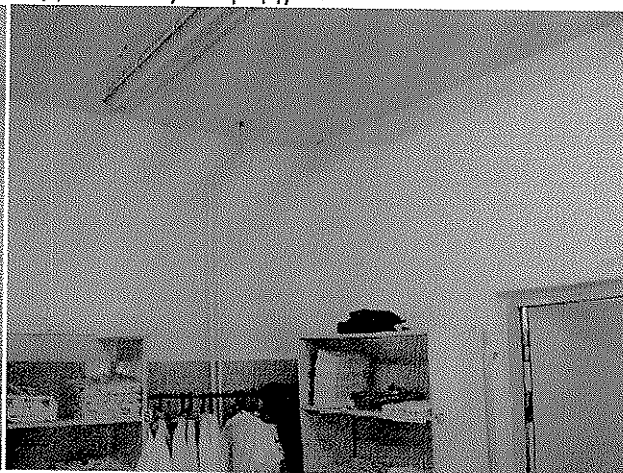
и №65. Помещение в осях «4-5» - вид на стену по ряду «В»
